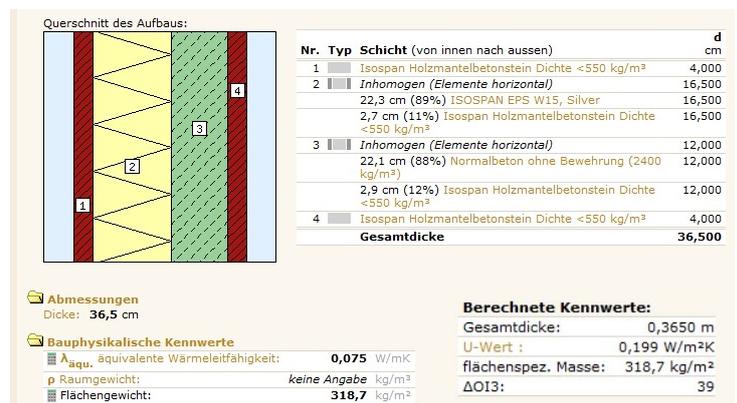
Holzmantelbetonstein Fa.Isospan [33]
